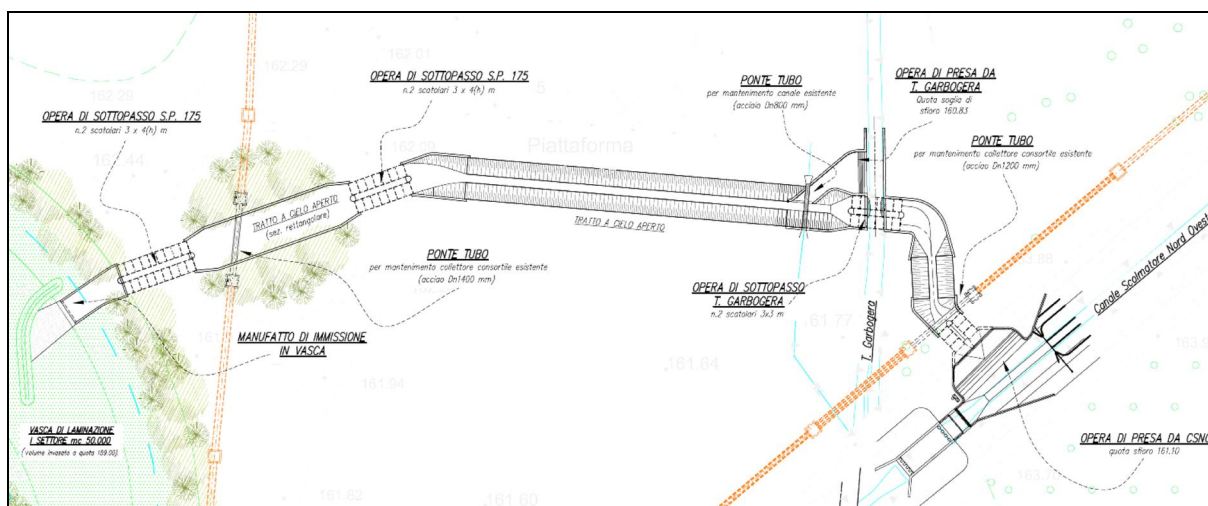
Planimetria del canale di alimentazione dell'invaso
